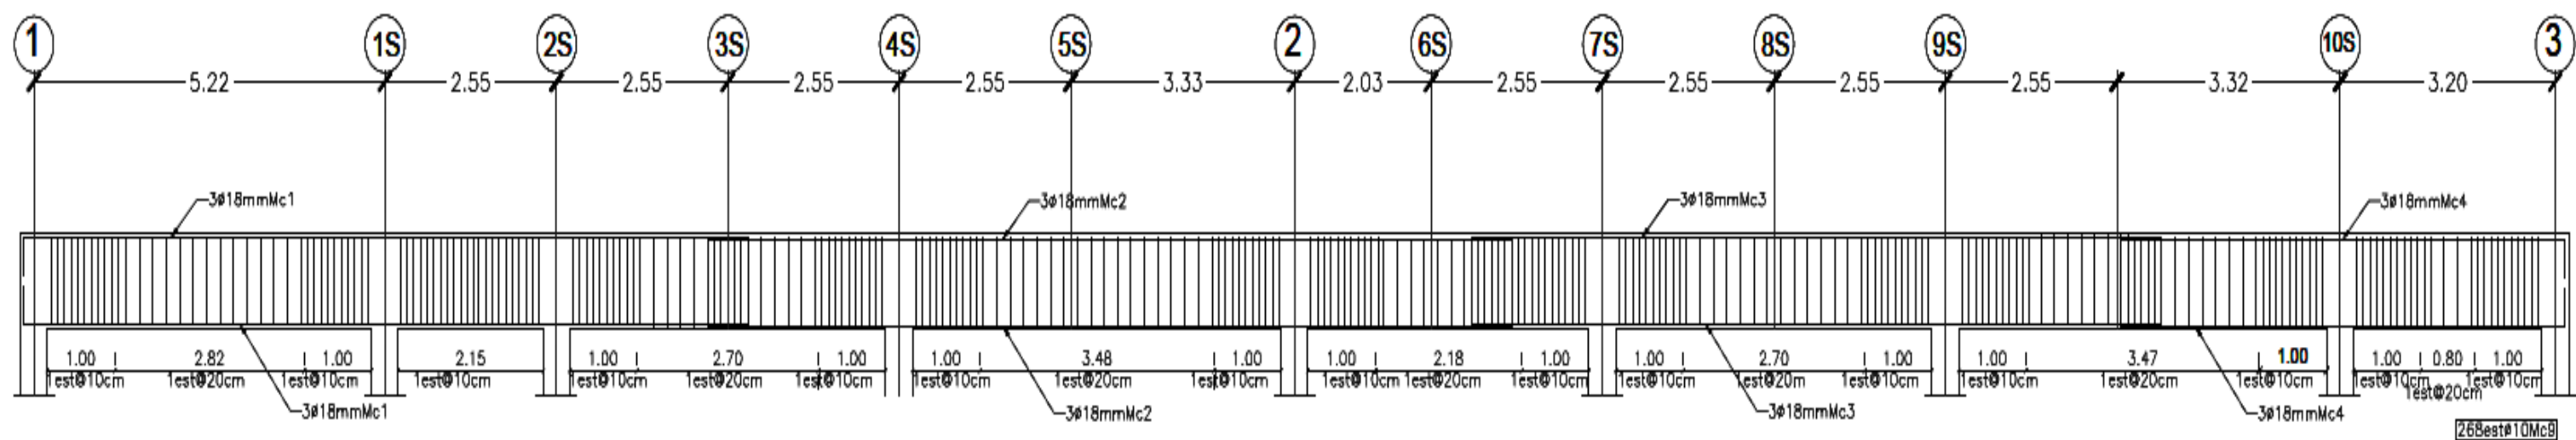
Detalle de armado viga 50 cm x 50 cm, corte longitudinal
